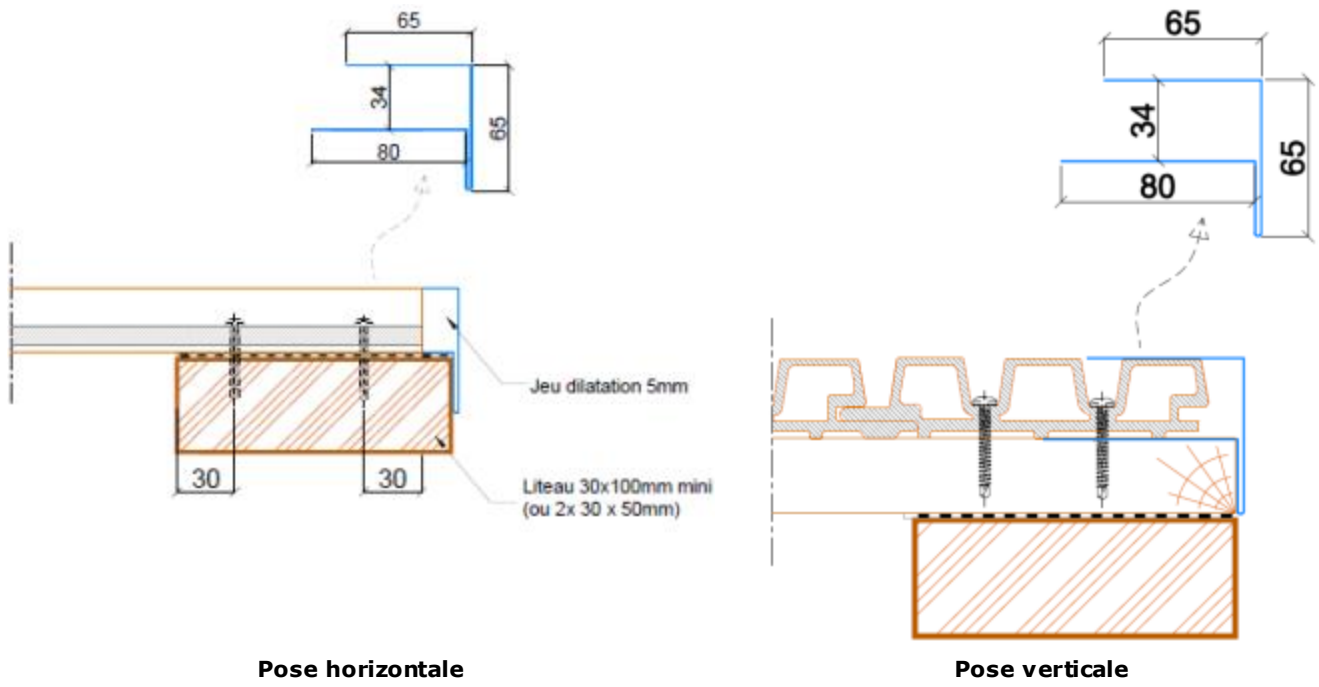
Coupe horizontale sur arrêt latéral sur ossature bois
